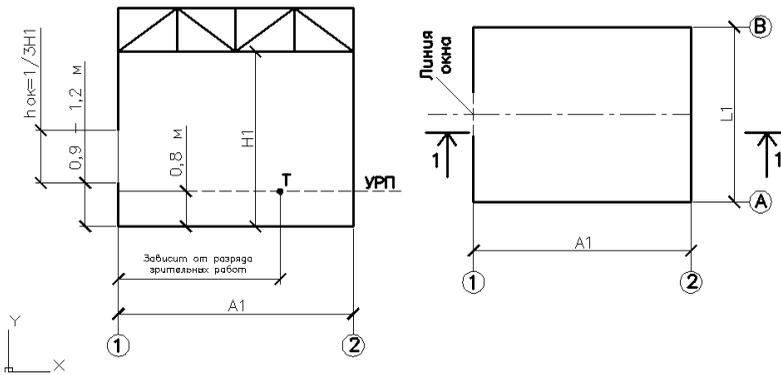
Схема плана и разреза к расчету бокового освещения
